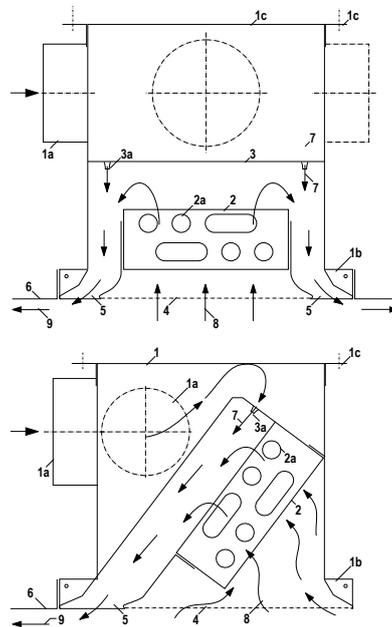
Construction et fonctionnement d'un convecteur actif de refroidissement de plafond DK-LIG
